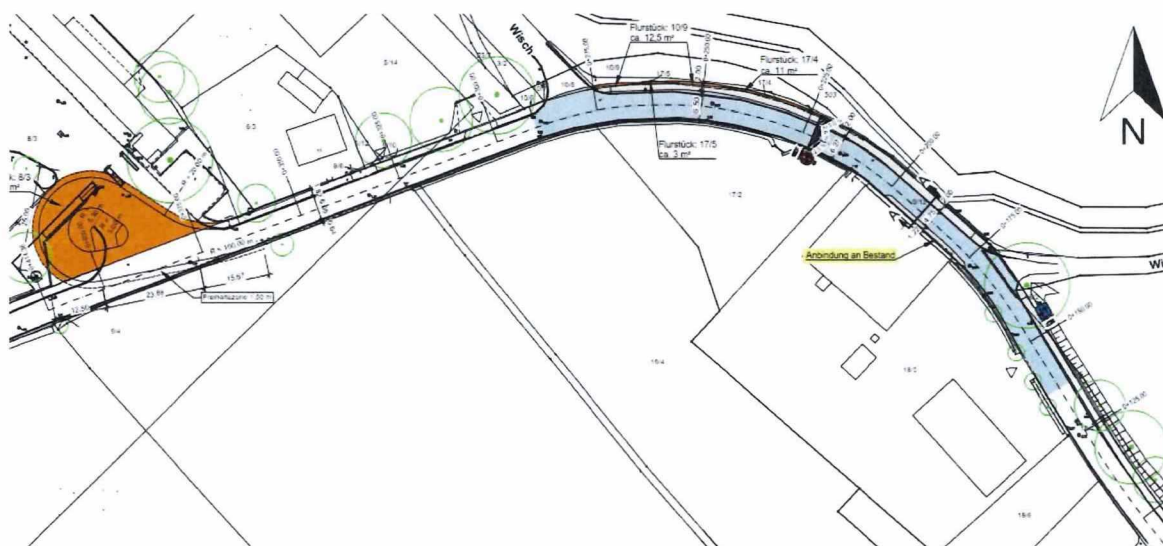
Lageplan Umgestaltung Heinrich-Hertz-Straße Straßenbau, d+p, April 2020, maßstabslos
